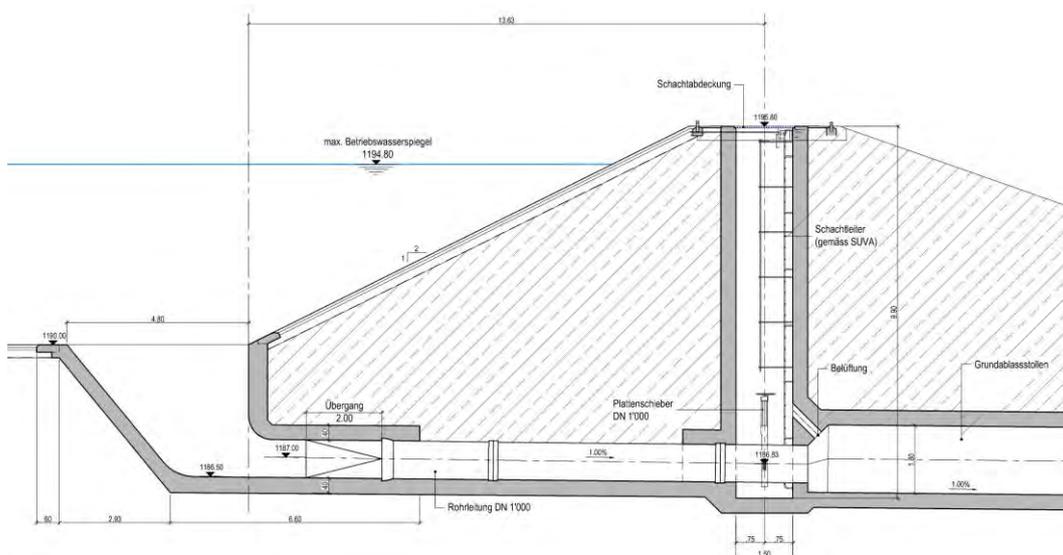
Schnitt durch den geplanten Grundablass.
